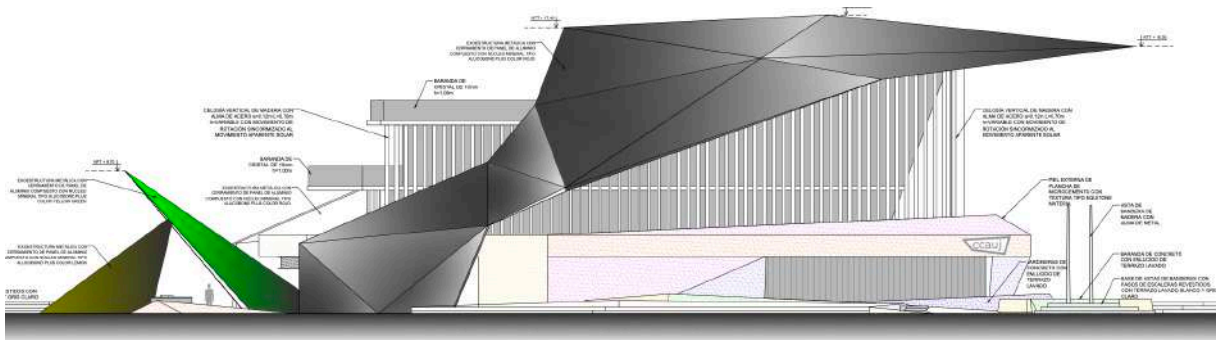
ELEVACIÓN ESTE CCAUJ
